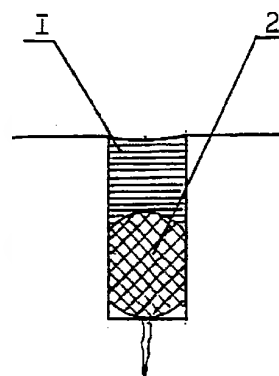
Гидроизоляция активных трещин.
